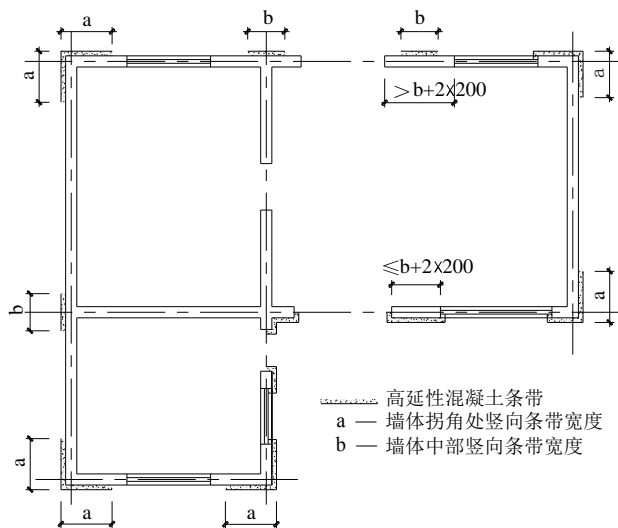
高延性混凝土竖向条带设置平面示意图
